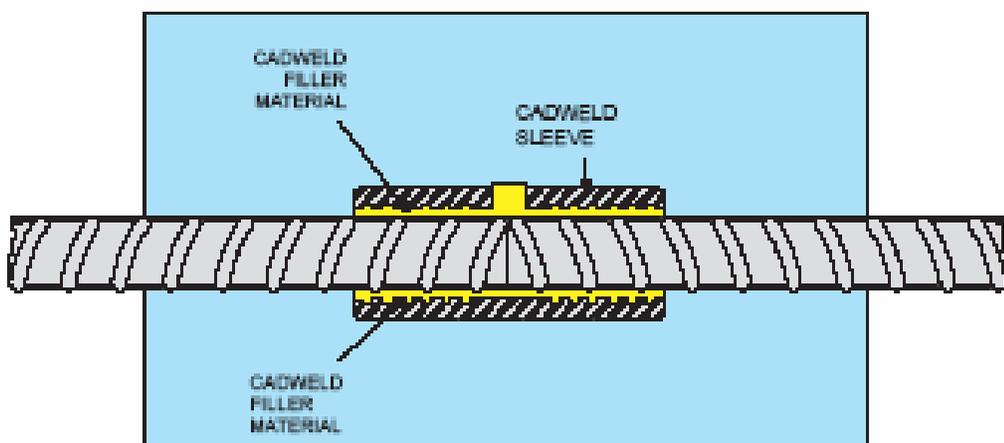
Empalme mecánico tipo Cadweld Rebar.
